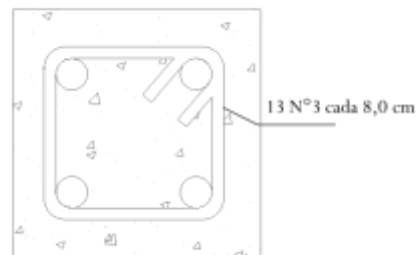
Corte transversal de la viga con detalle de diseño a cortante
